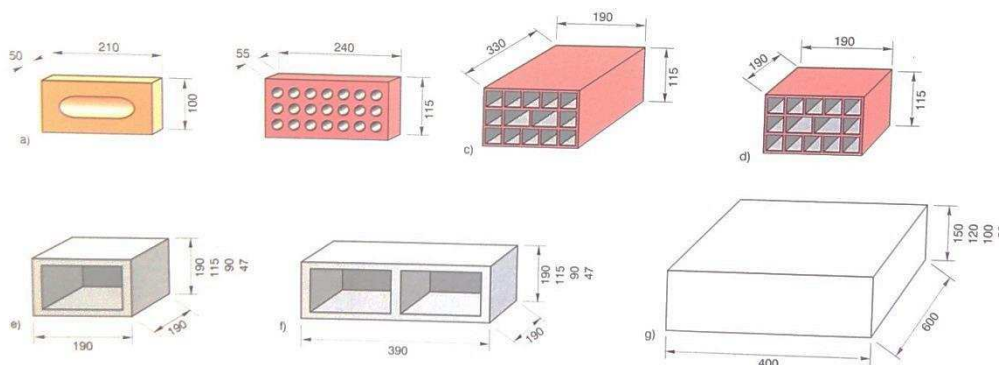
a) Tijolo maciço de barro cozido; b) Tijolo laminado de 21 furos; c) Bloco cerâmico vazado; d) 1/2 bloco cerâmico vazado; e) 1/2 bloco de concreto; f) Bloco inteiro de concreto; g) Bloco de concreto celular (dimensões em mm) (DIAS, 2002).
